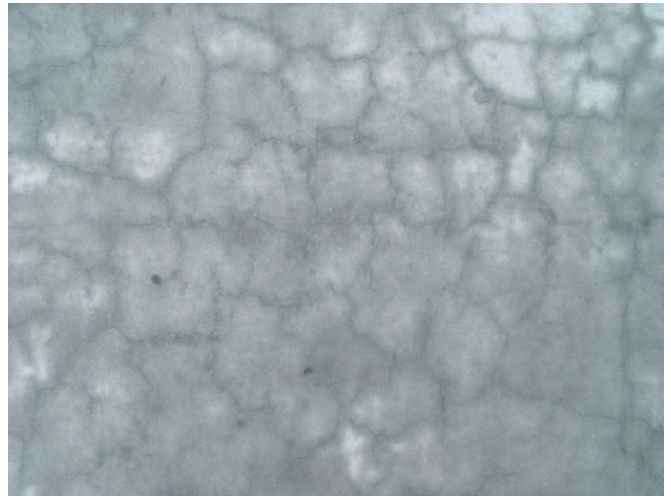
Patrón típico de fisuración por contracción plástica en una losa de concreto
